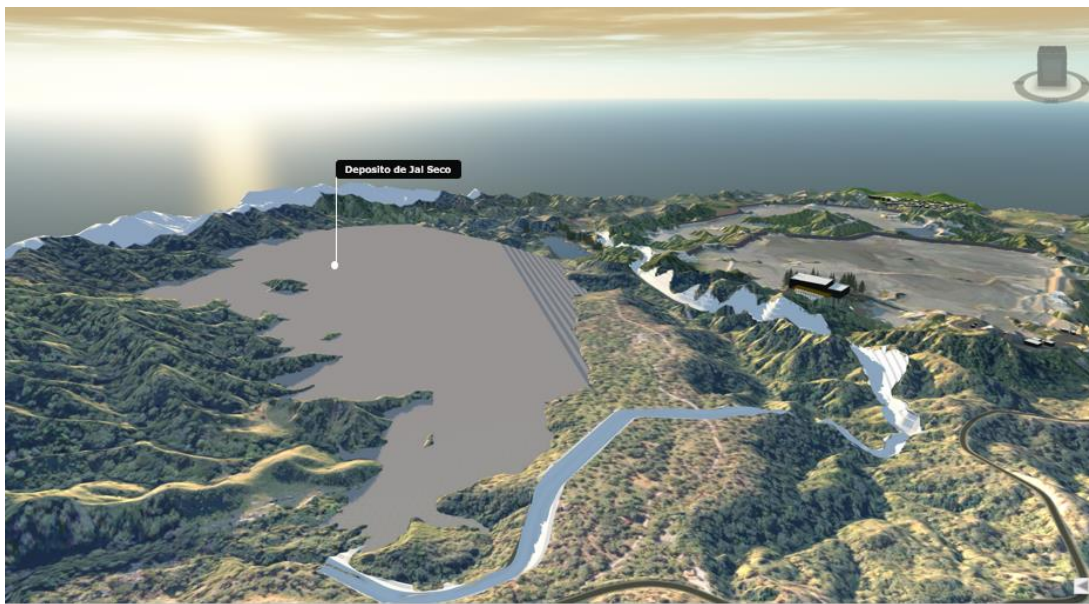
Vista en planta de la distribución general en el depósito de jales secos.
